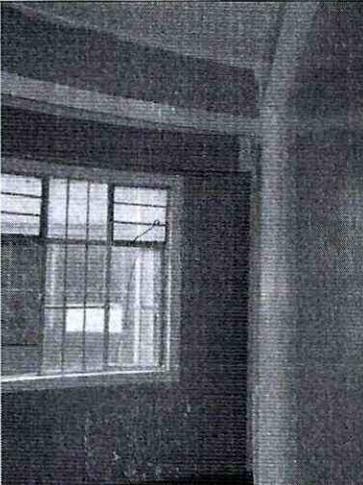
Primer piso. Muros sin daño aparente. Cielo raso madera con humedades y eflorescencias
